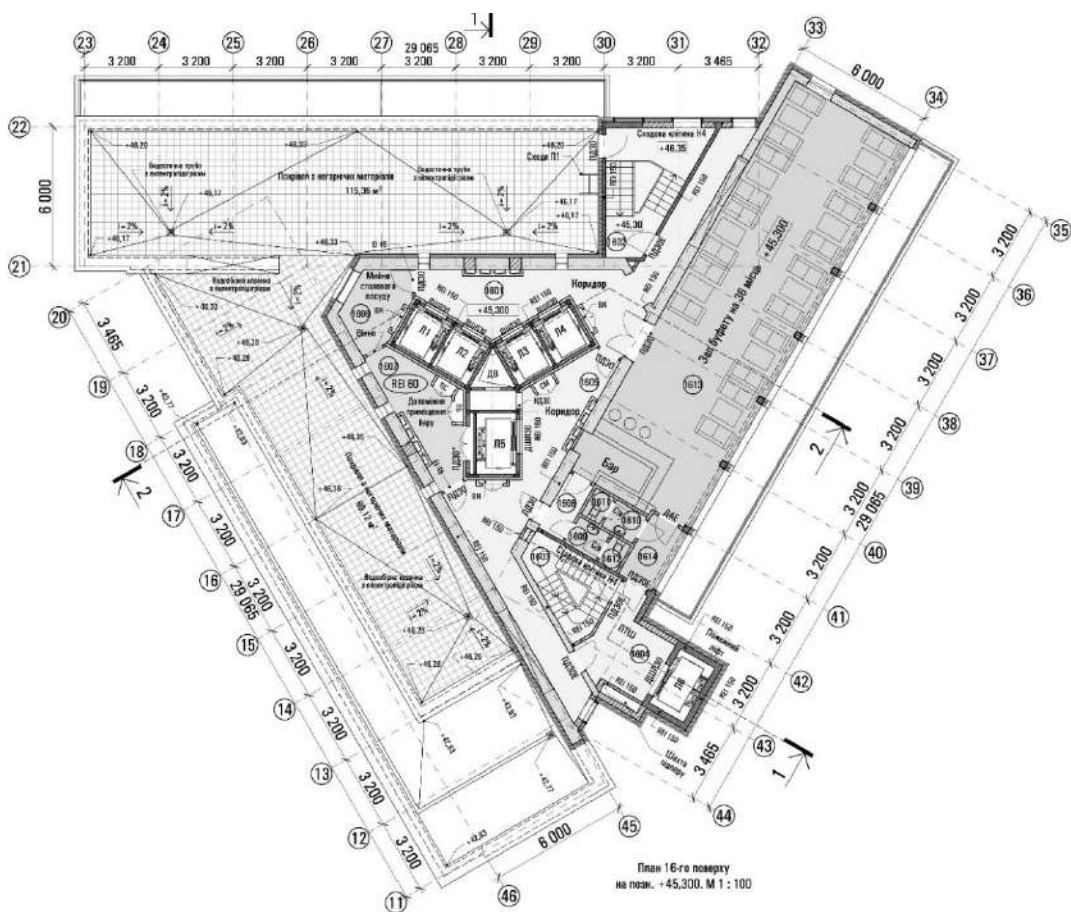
План 16-го поверху. «Скай-бар» з терасою.
